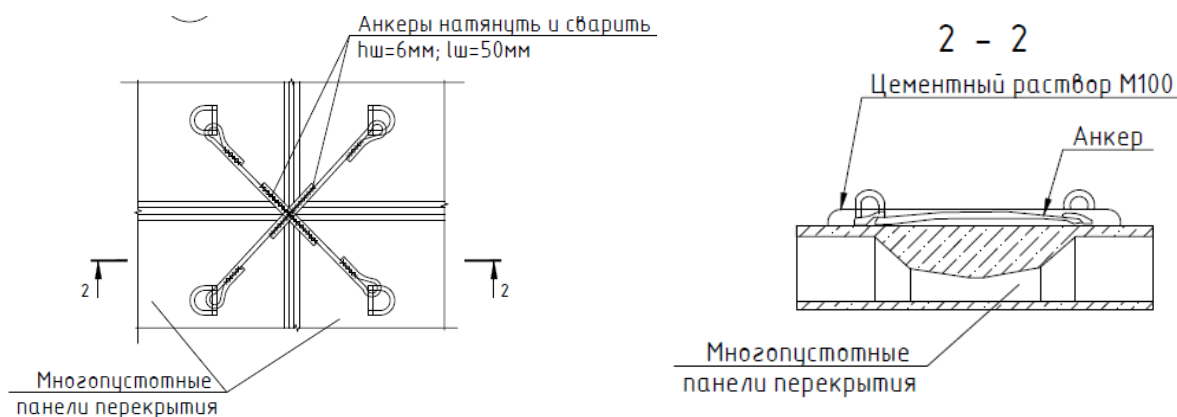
Перекрестная стяжка плит анкерами для четырех плит перекрытия
